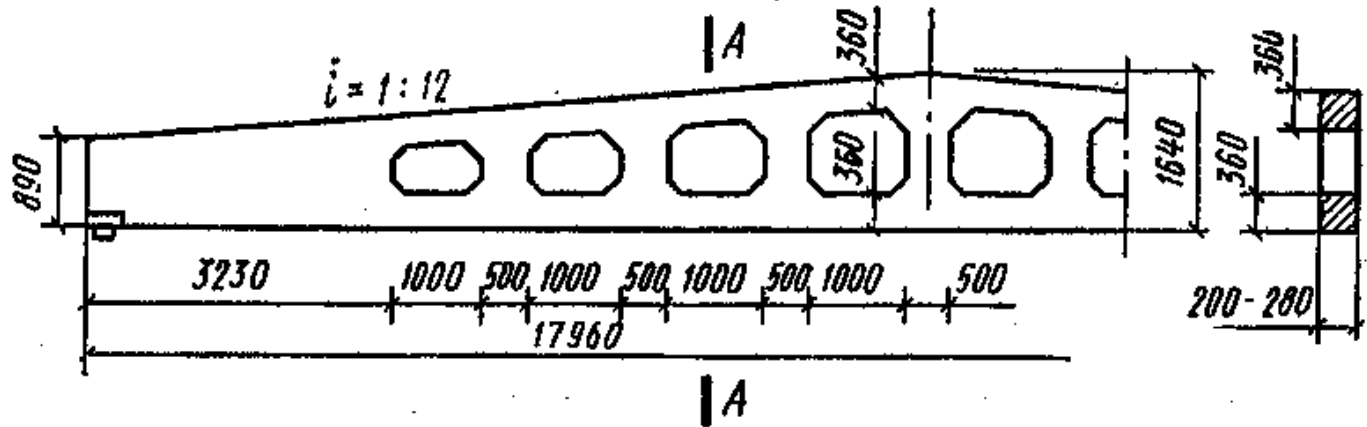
Двухскатная решетчатая балка покрытия прямоугольного сечения пролетом 18 м
